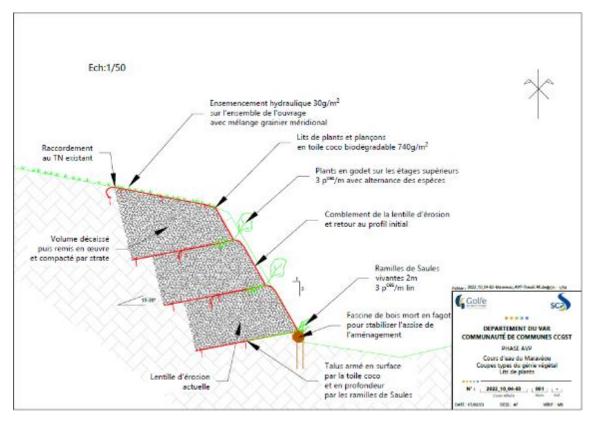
Coupe type Lit de plants-plançons (échelle : 1/50)
